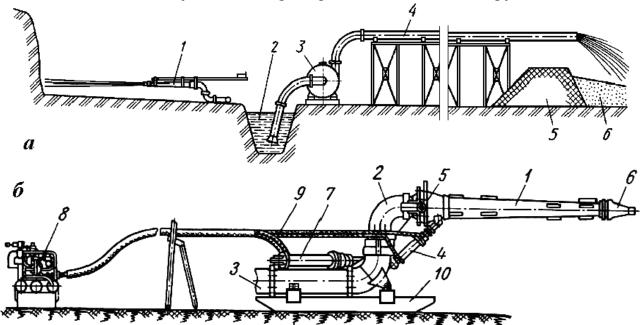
Схема разработки грунта гидромонитором (а); гидромонитор (б)
